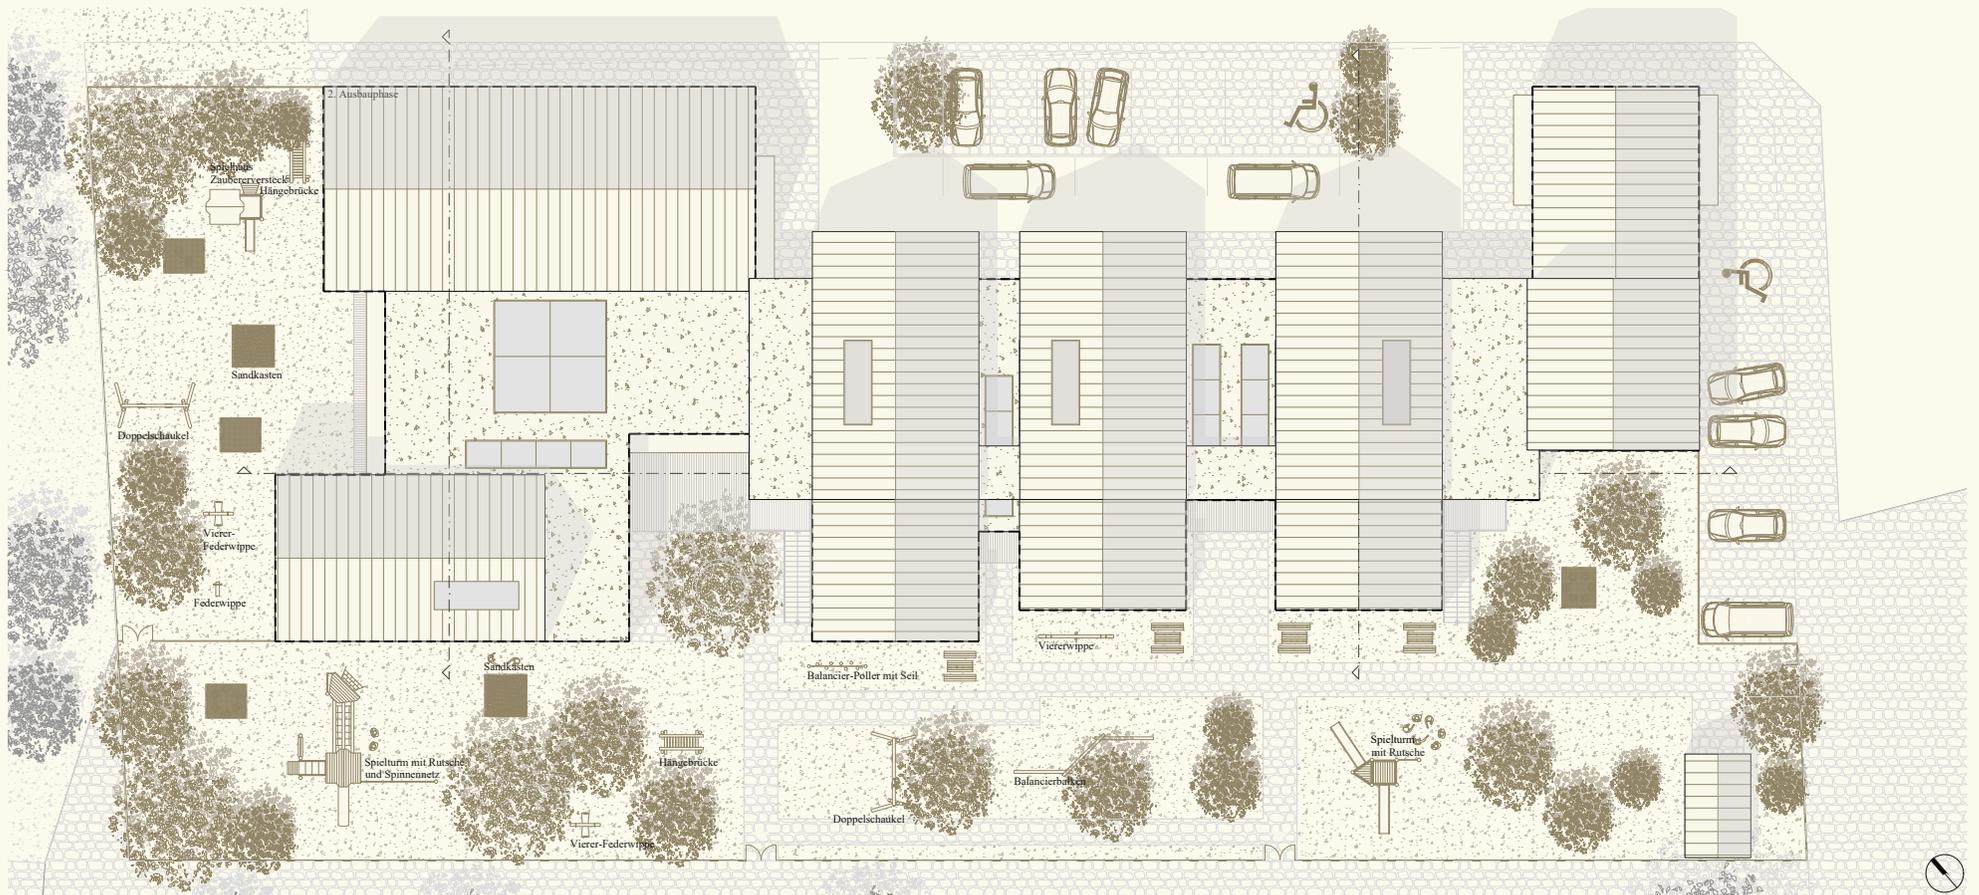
, Grundriss Dachdraufsicht | 1:400
